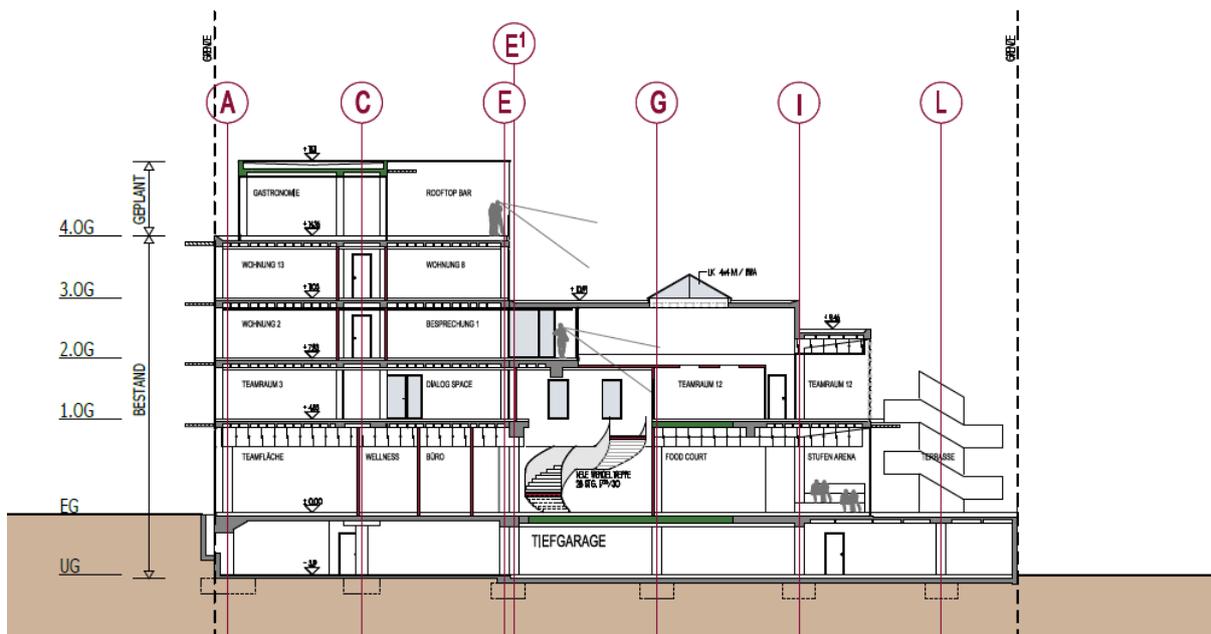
Längsschnitt – zurückgesetztes Staffelgeschoss und rückwärtig abgestufte Gebäudehöhe
